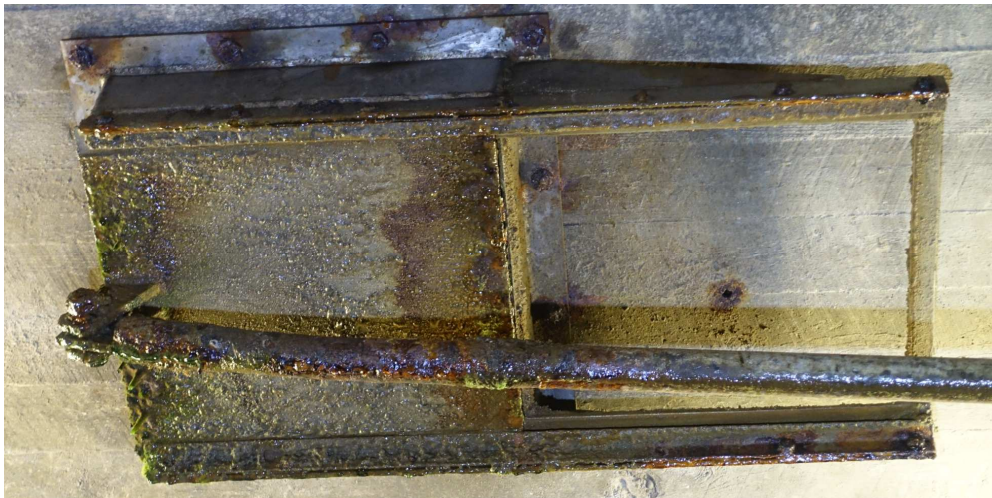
Foto på ståldetalj på betongpelarnas hörn.
